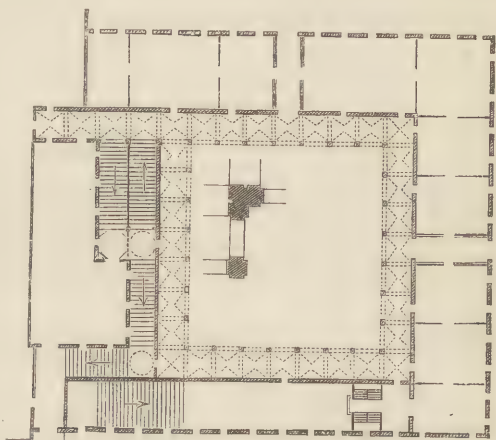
Palazzo Laterano zu Rom. Grundriss.
